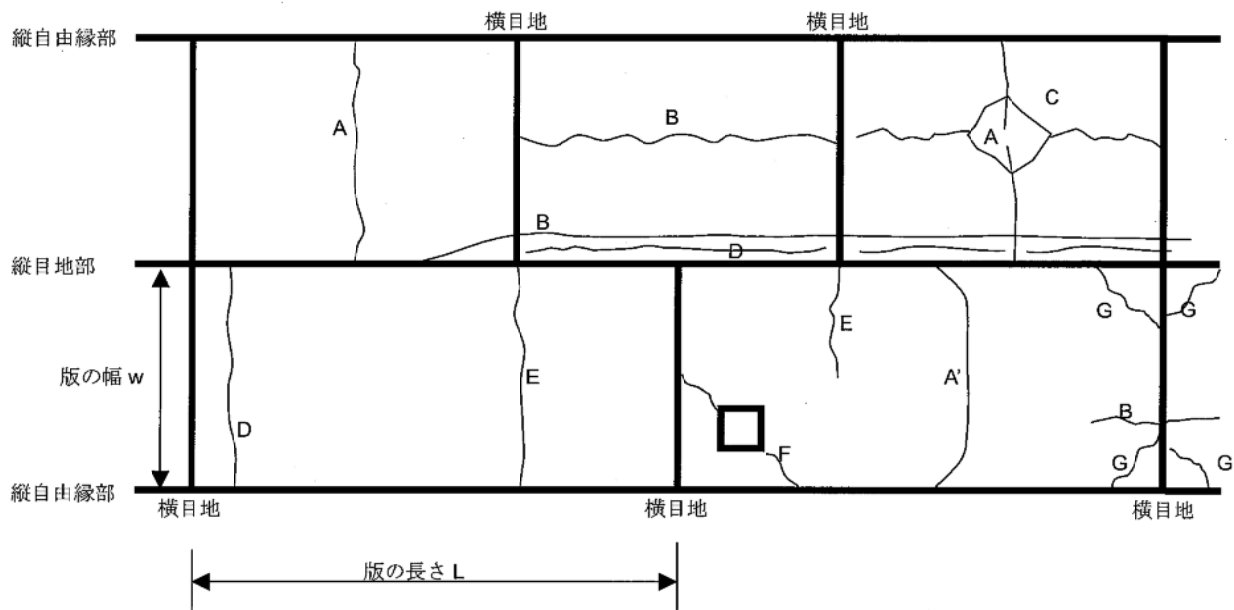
構造的なひび割れ発生パターン (平面図) ⁽⁵⁾
